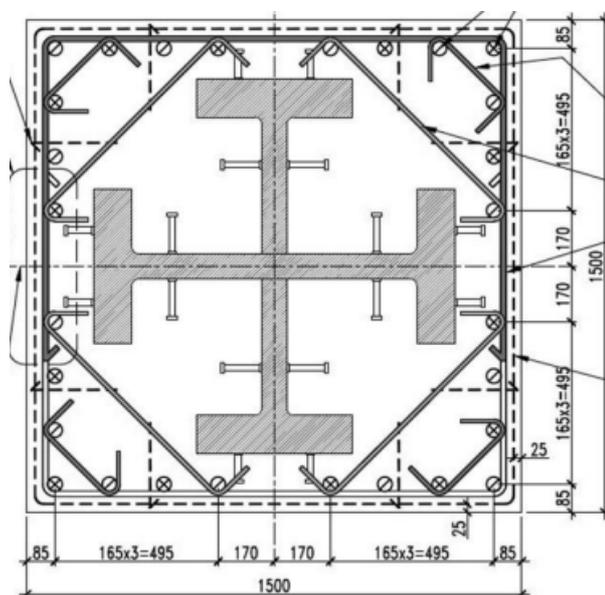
Сечение сталежелезобетонной колонны
